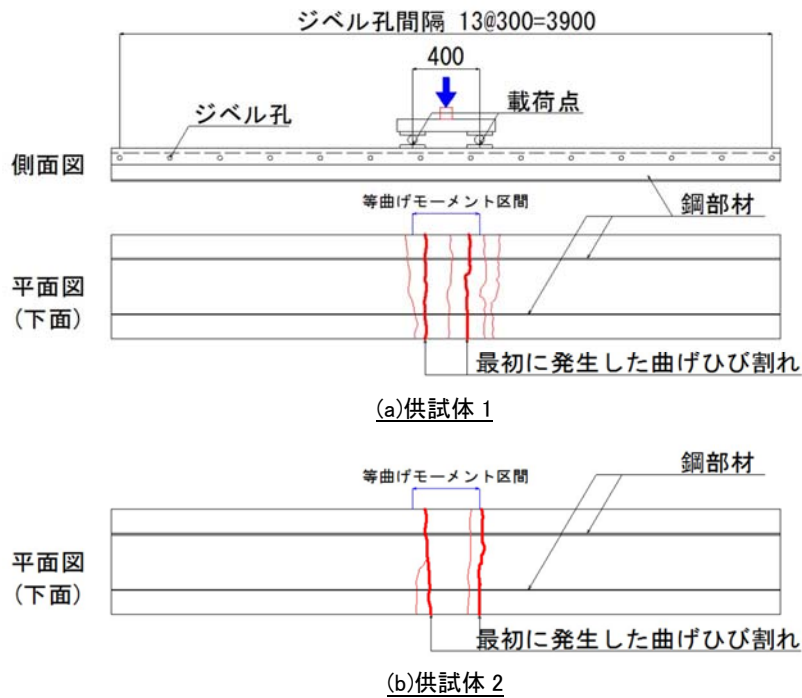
コンクリート下面の曲げひび割れ状況
